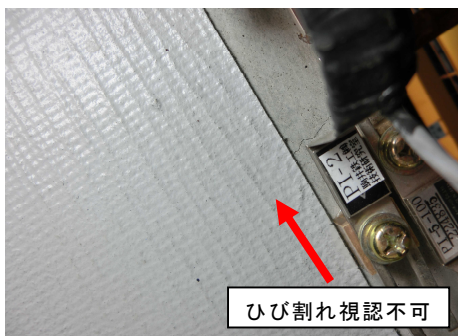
AZX1 ひび割れ発生時 (下面拡大)
